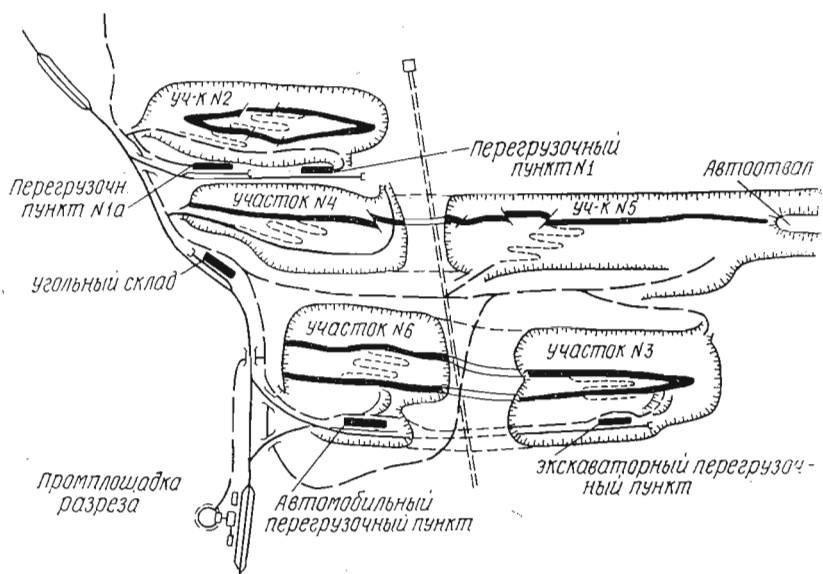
Схема вскрытия поля разреза им. Вахрушева
